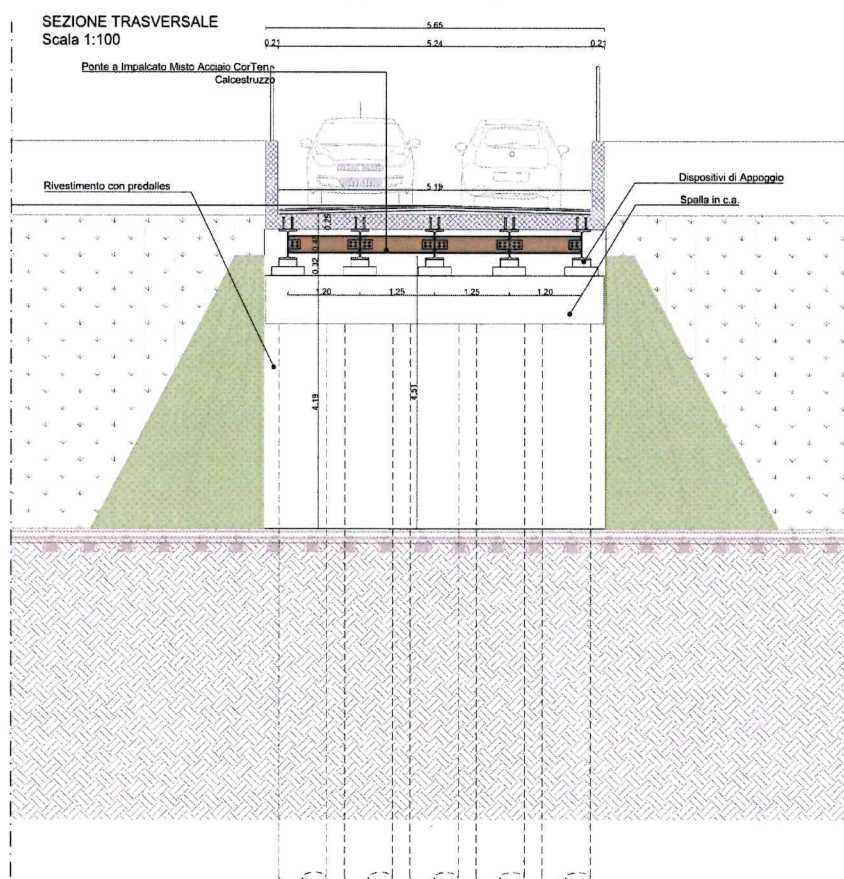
Sovrappasso in muratura km 21+900 – Progetto – Sezione Trasversale
